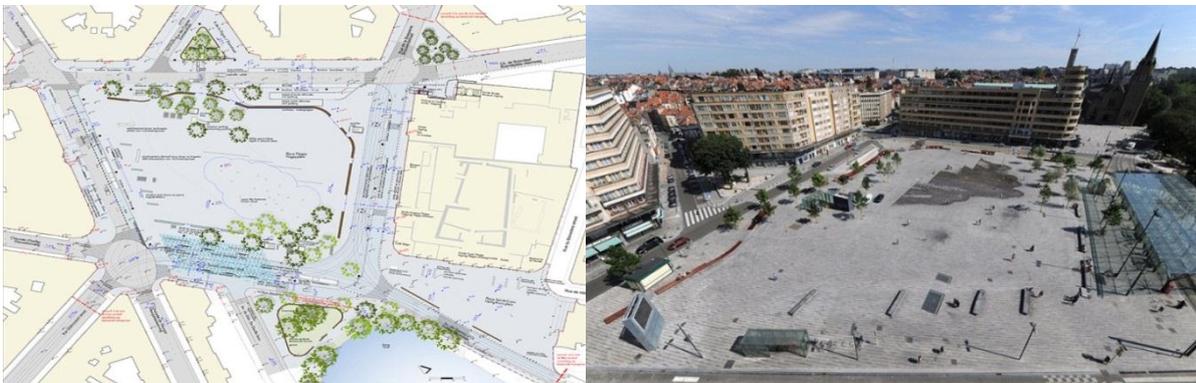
Plan et photo de la place Flagey, Bruxelles, (Source: web)
